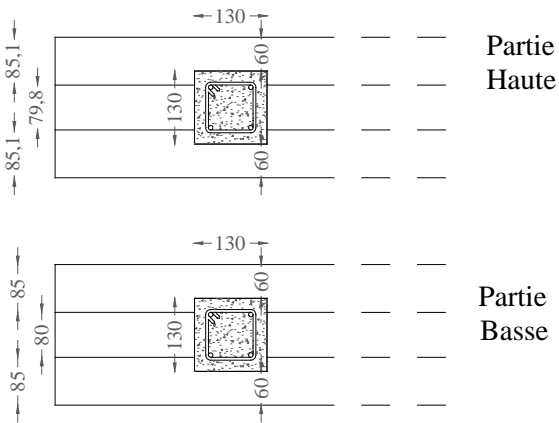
Détails 1 et 2 en plan avec le ferrailage vertical
